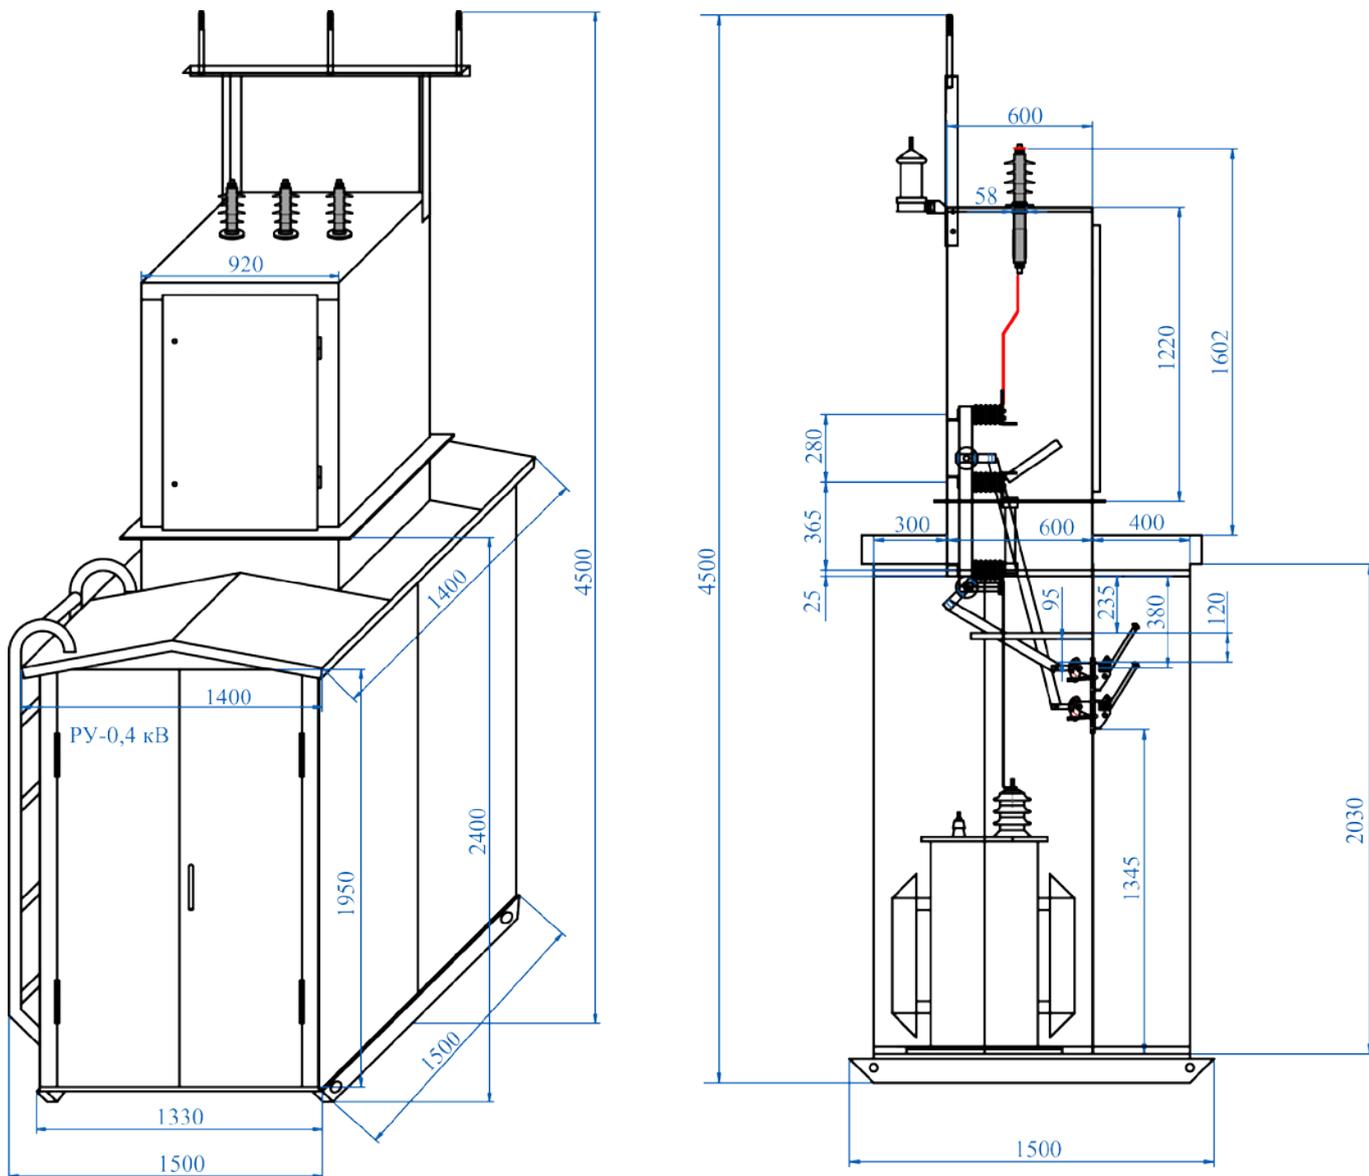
Внешний вид и габаритные размеры КТПН – 25, 40, 63 кВА
